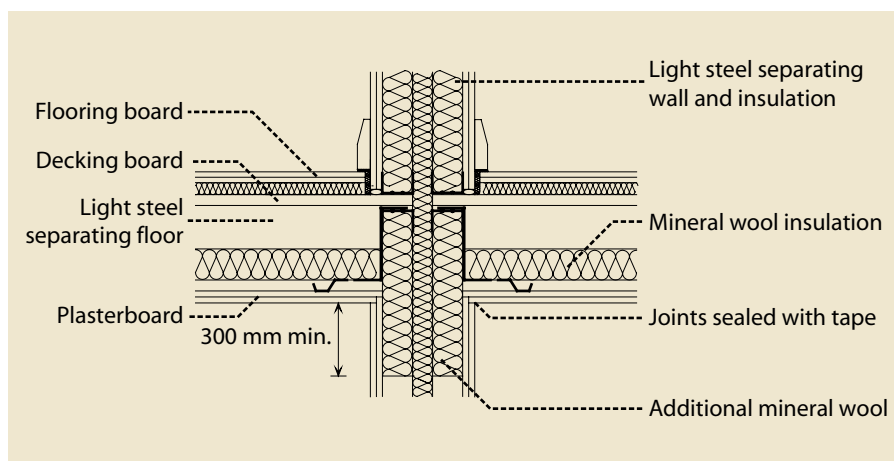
Aislamiento acústico en forjado de acero ligero y el detalle en las particiones interiores
